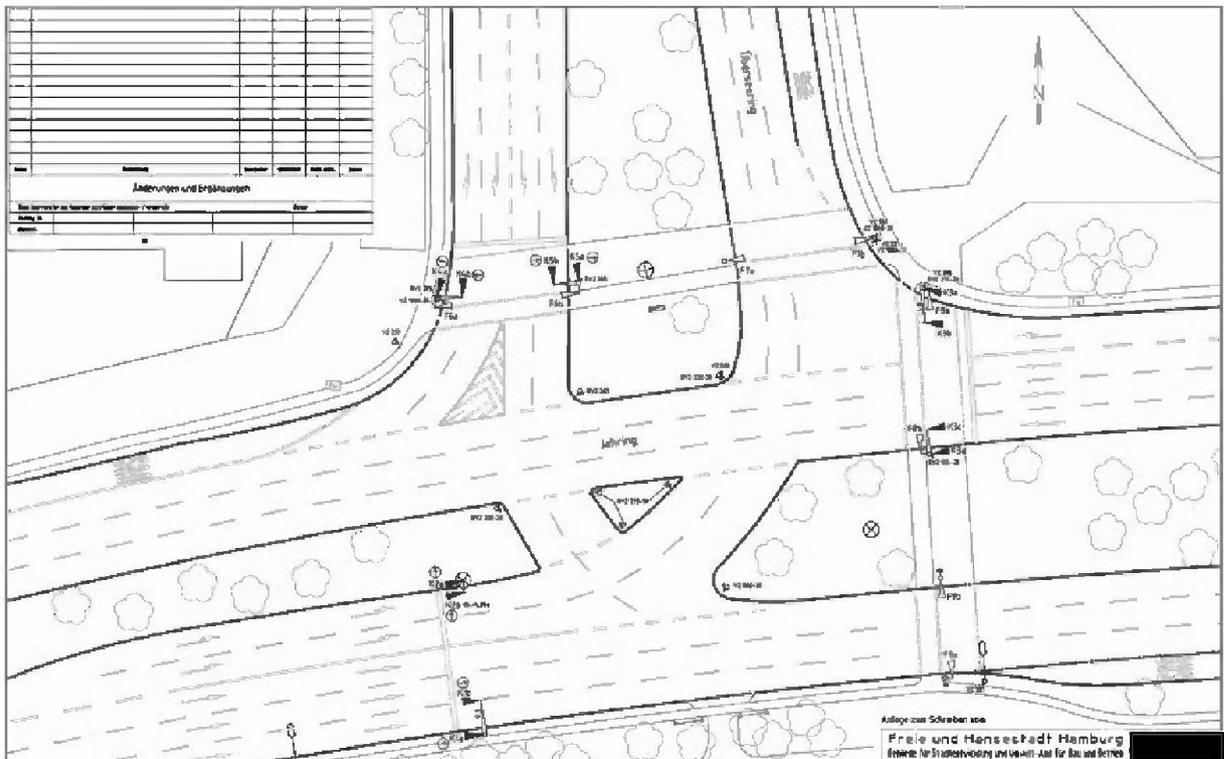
2 Signallageplanausschnitt LSA 959
